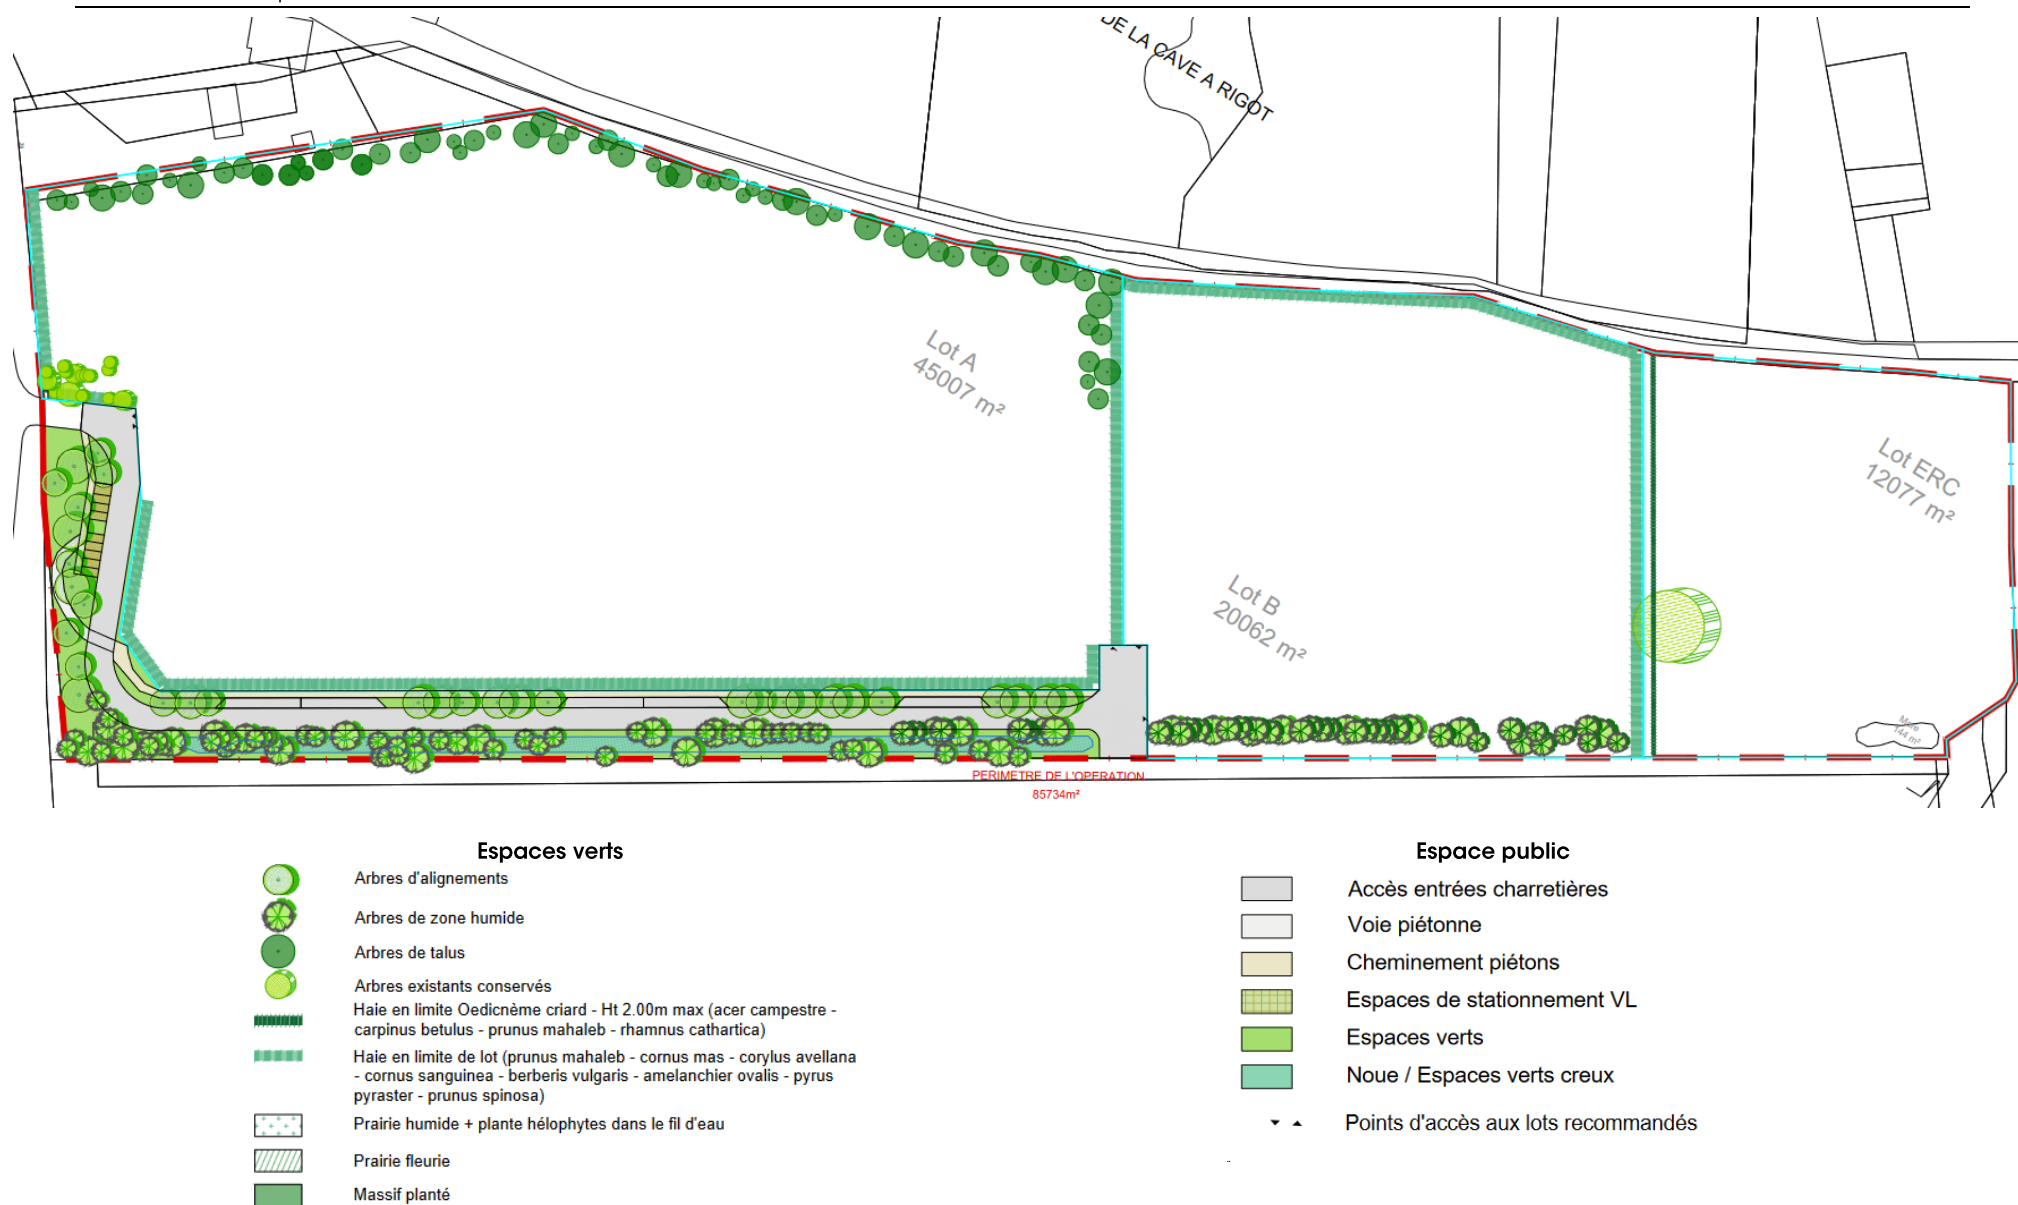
Plan de principe des propositions d'aménagements et prescriptions paysagères sur les lots privés (Plan provisoire)
